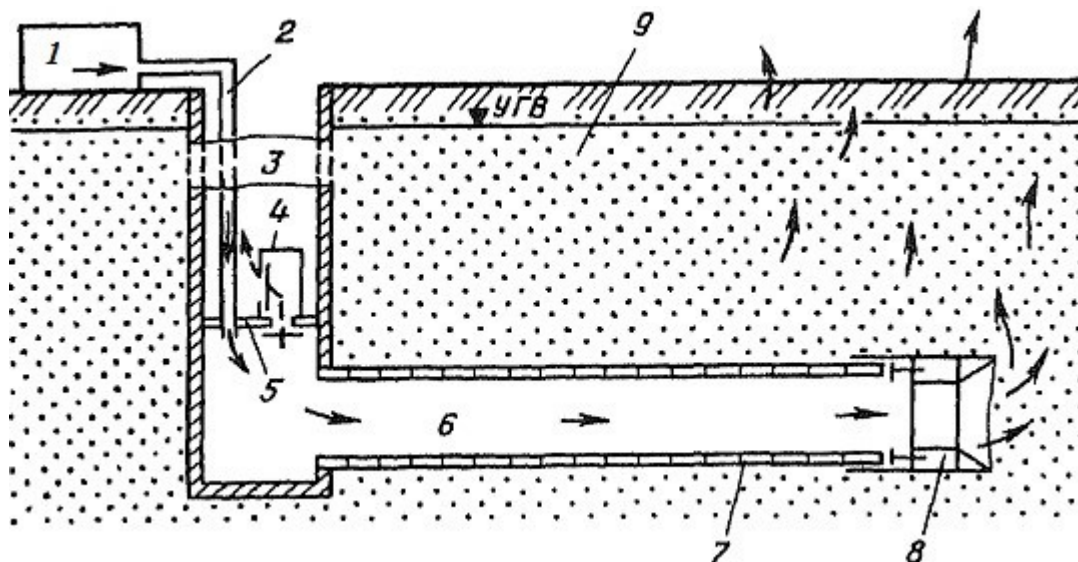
Схема проведения выработки под сжатым воздухом: 1 - компрессорная станция; 2 - воздухопровод; 3 - ствол шахты; 4 - шлюзовая камера; 5 - герметичная бетонная перемычка; 6 - рабочая зона кессона; 7 - тубинговая обделка; 8 - щит; 9 - водонасыщенный грунт; УГВ - уровень грунтовых вод.
